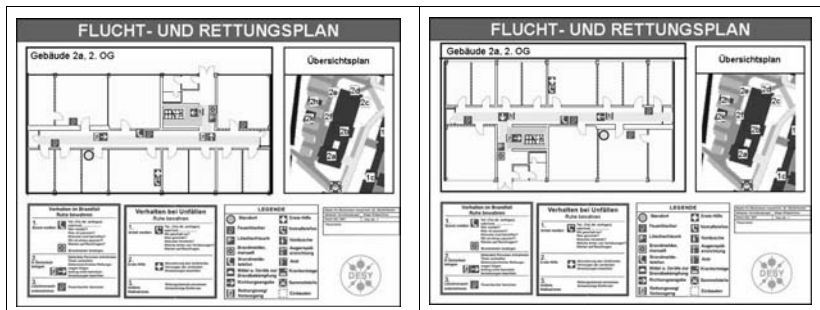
FuR-Plan mit eingezeichnetem Standort im Etagenplan.
